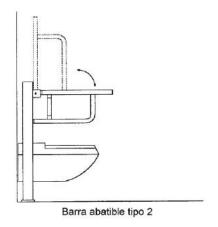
Barras de apoyo. Forma y disposición (Dimensiones en mm)
